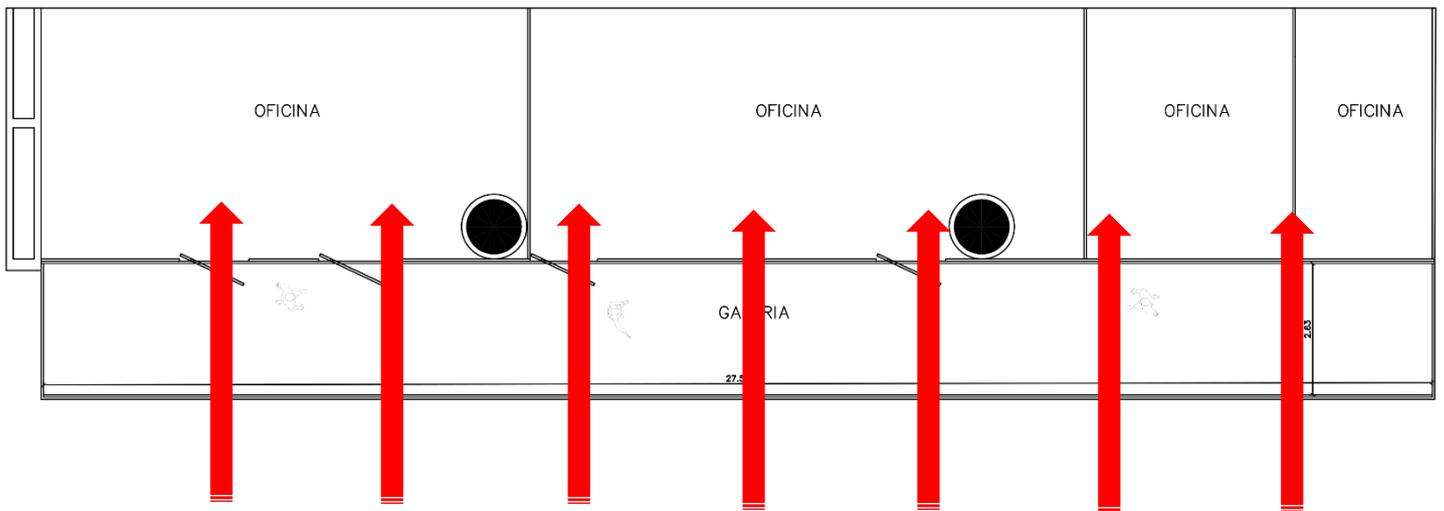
Elaboración propia. Planta arquitectónica. Sector oficinas.
